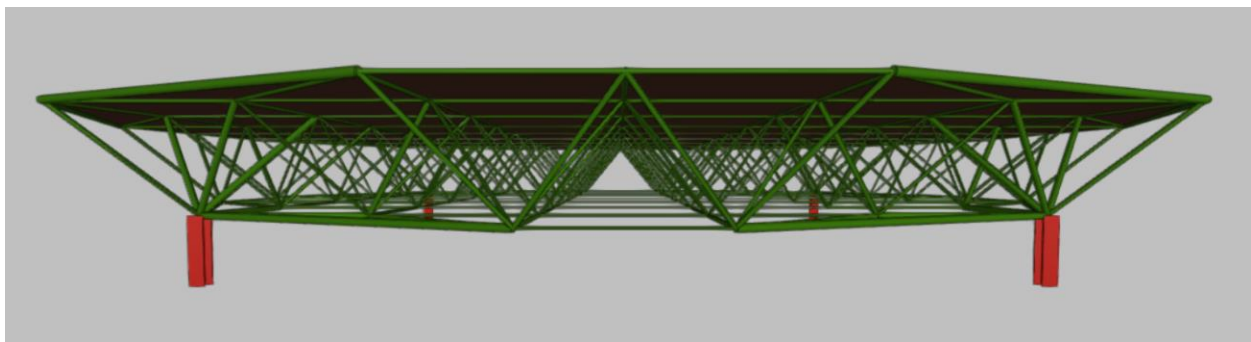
Estructura tras la comprobación y dimensionamiento - vista lateral.
